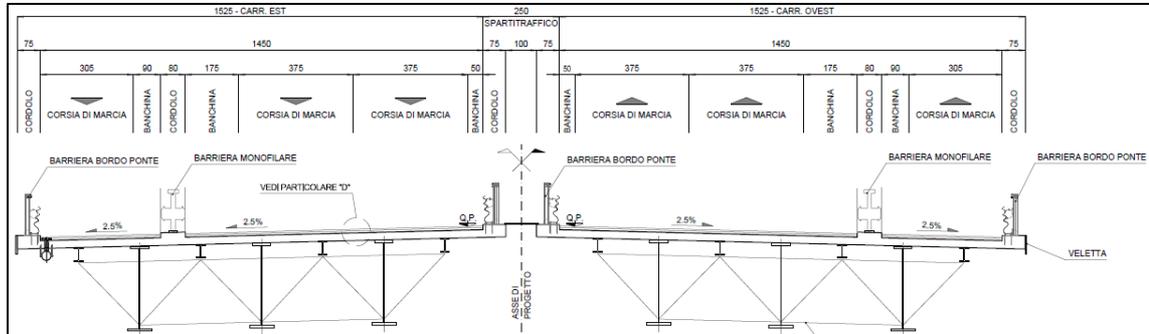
Sezione tipo asse principale Viadotto Candelaro
